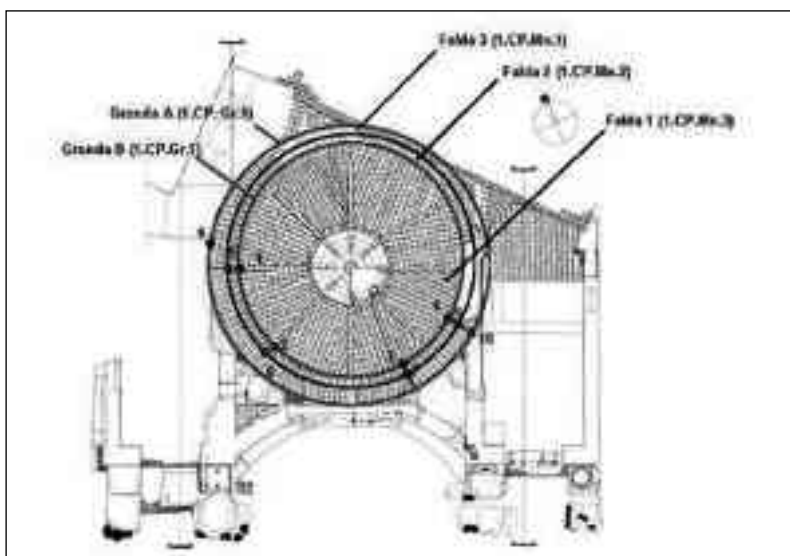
Planimetria copertura con indicazione di gronde e pluviali
